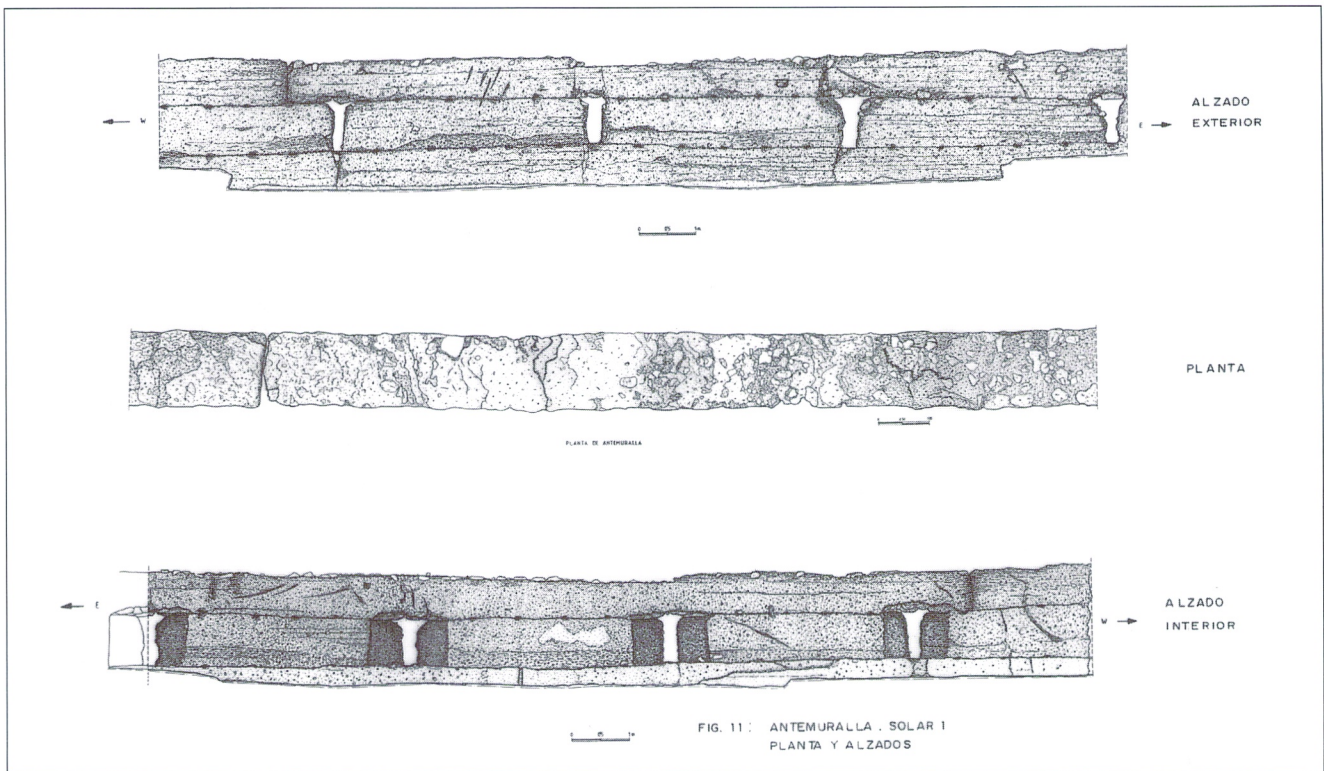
ANTEMURALLA, SOLAR I, PLANTA Y ALZADOS.
